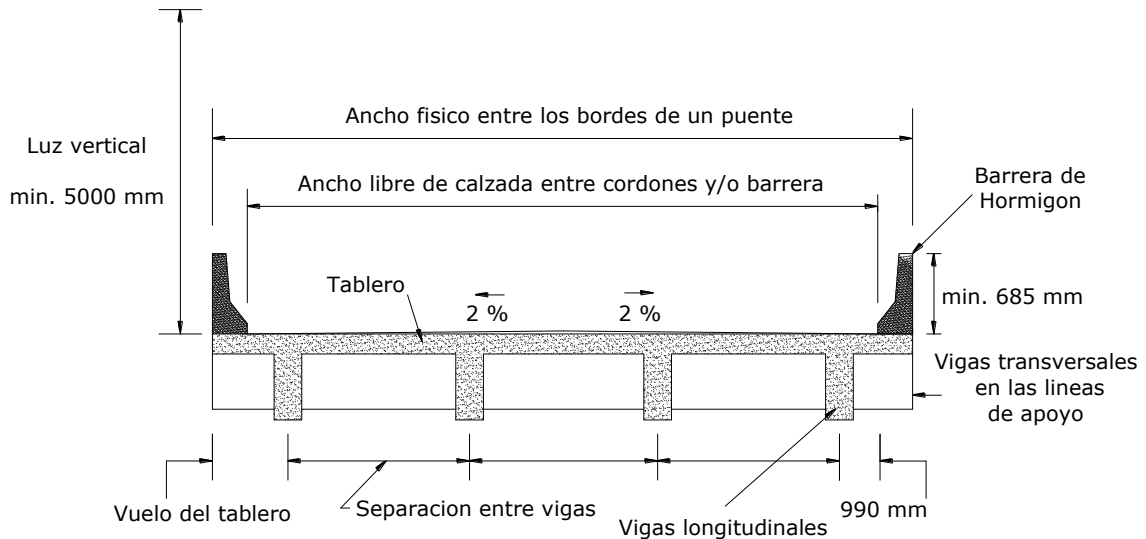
Tablero y estructura portante, puente Viga-Losa
